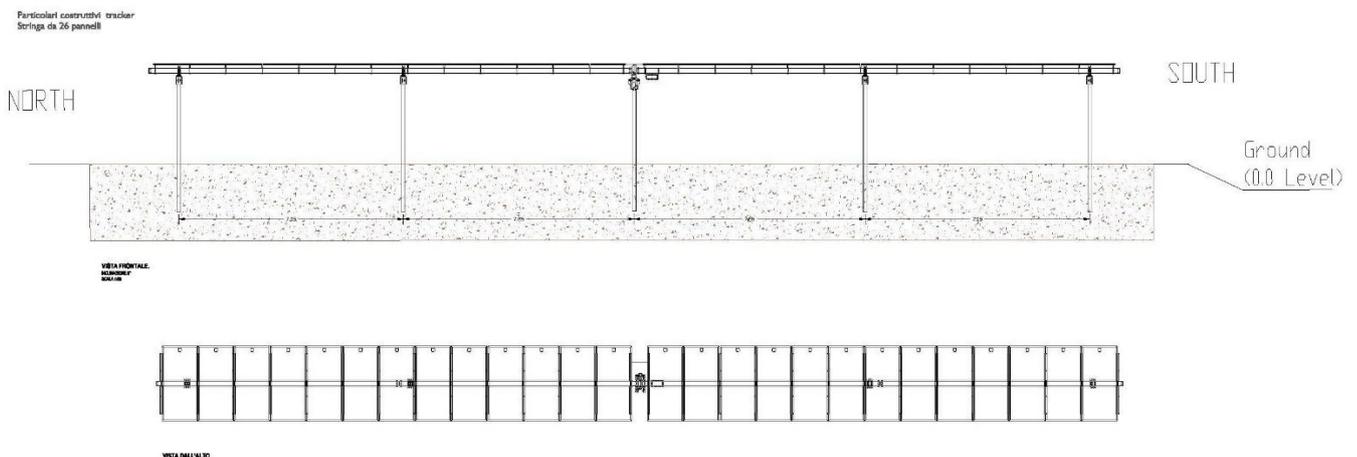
Vista laterale e vista dall'alto della singola stringa da 26 moduli
